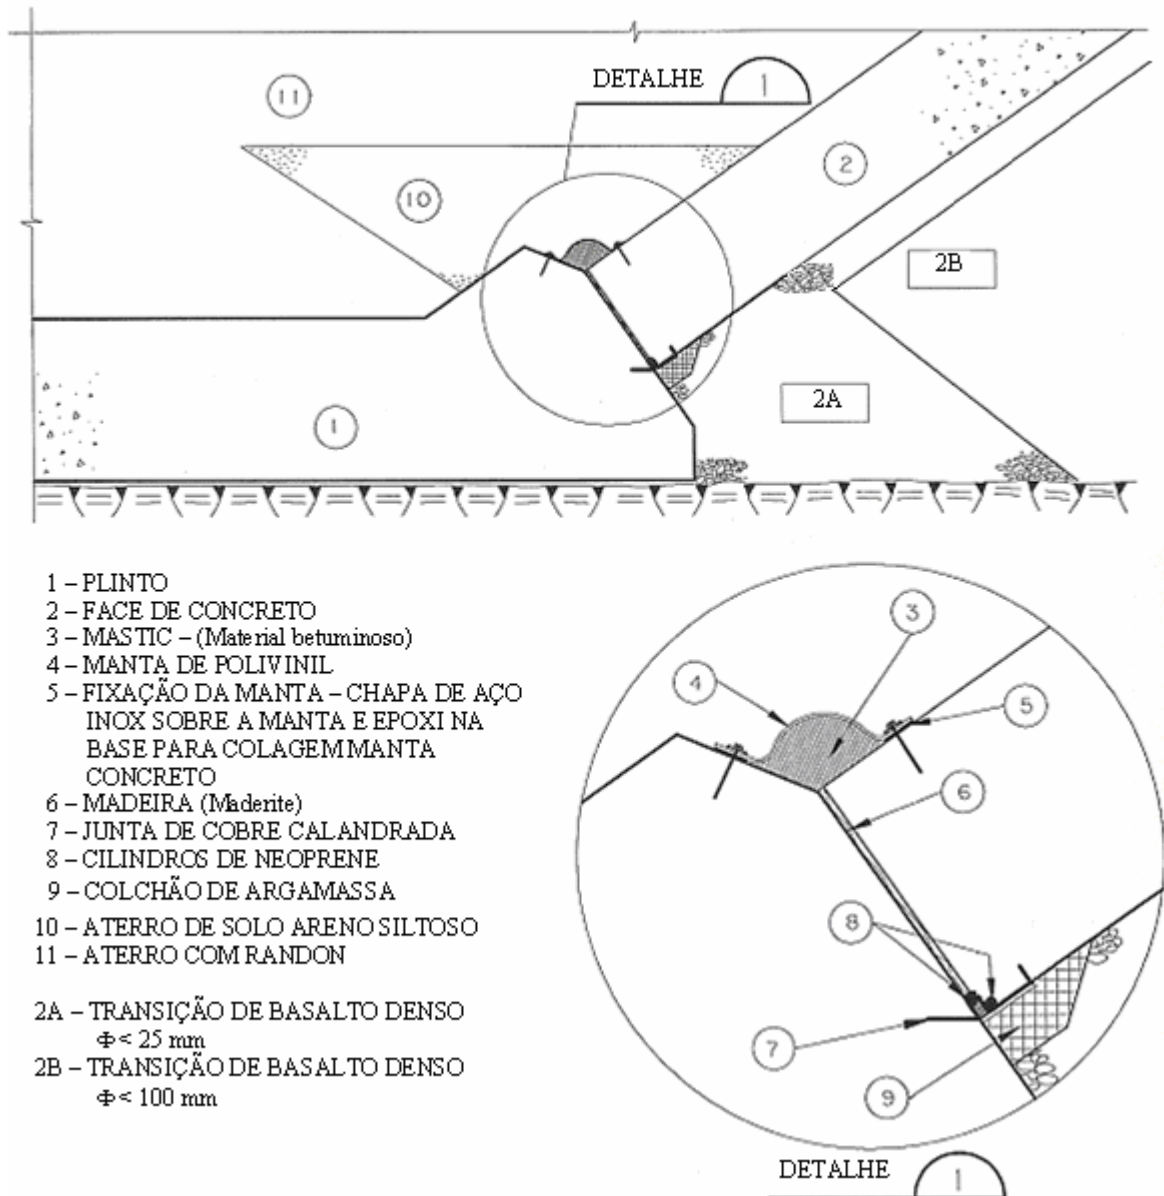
Detalhes do aterro de proteção na região central executado sobre o plinto.
